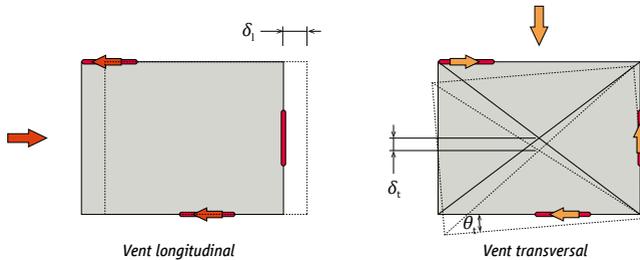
Configuration stable avec 3 plans de contreventement (non recommandée)
